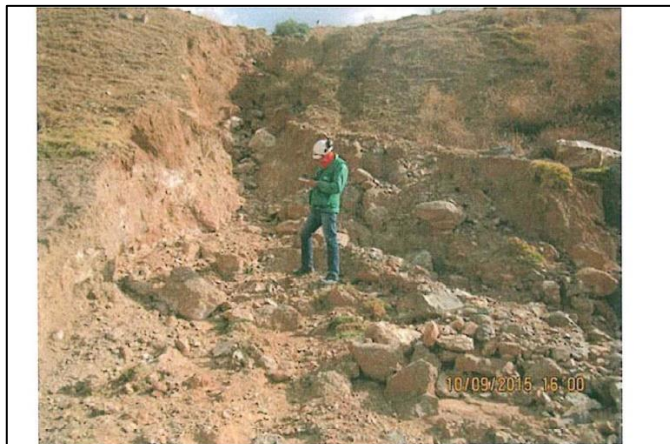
La descarga del canal perimetral (de coronación) del Tajo Gentiles ha provocado erosiones del suelo. Hallazgo N° 19.
